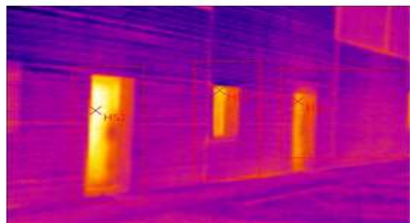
Теплотехнический расчет ограждающих конструкций – наружная стена
